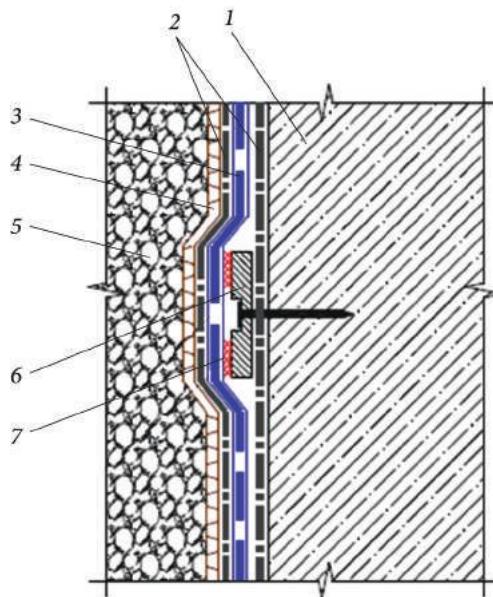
Схема крепления ПВХ мембранны к вертикальной стене:
